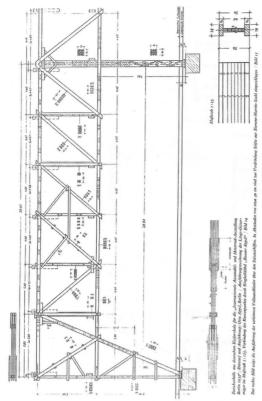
Sistemas de construcción de cerchas con madera laminada (AHCOAM GM/CP077/C1-31)
